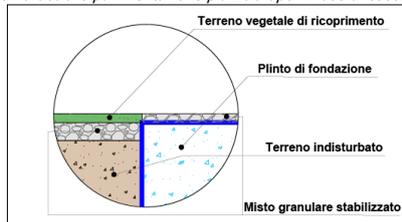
Particolare pavimentazione piazzola tipo in fase di esercizio
